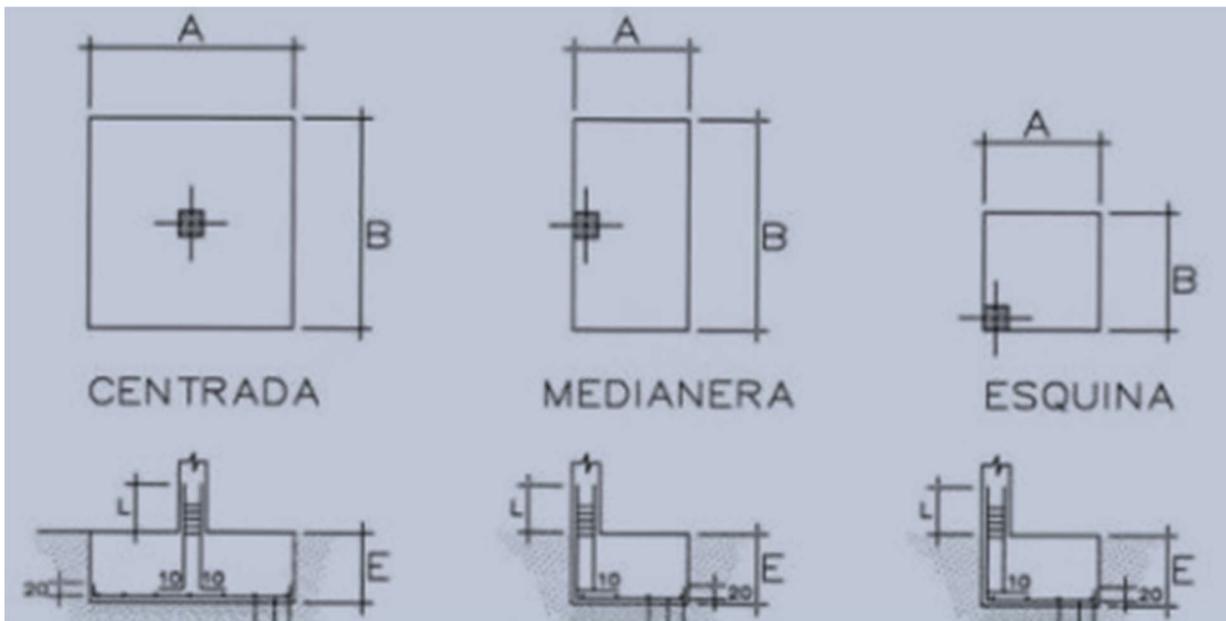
Clasificación de las zapatas de acuerdo a su ubicación en planta:
